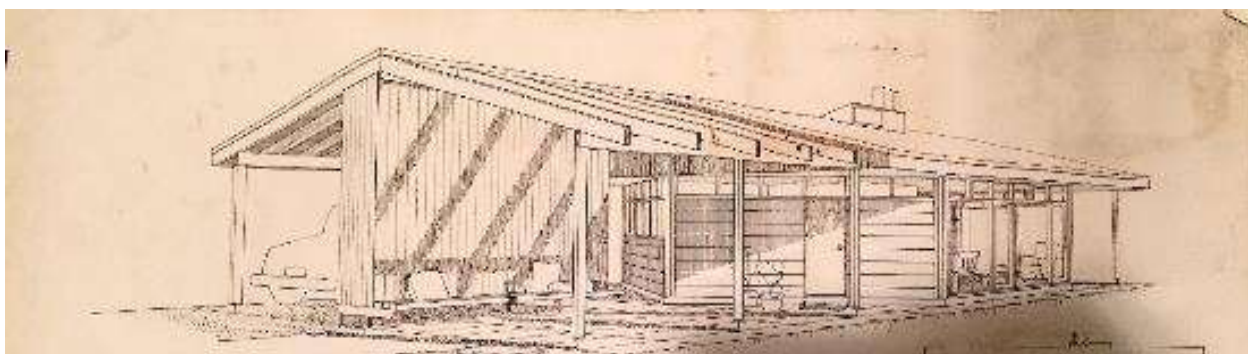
Detalle perspectiva de la Casa NAHB-Forum, en la cual es posible observar cómo la estructura de la cubierta da forma a el espacio del porche.
